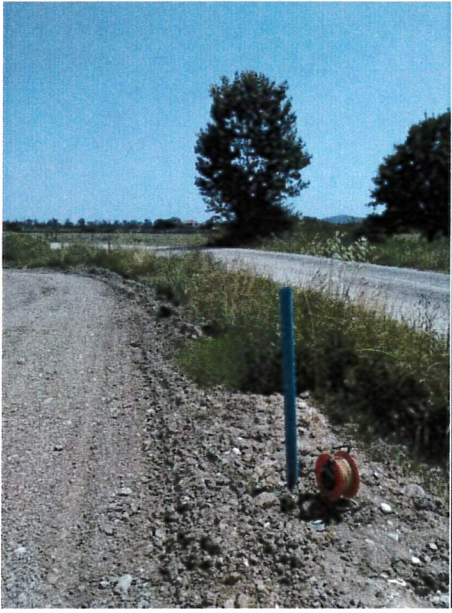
, 4: letture freatiche con sonda galvanometrica ai piezometri S1 e S2
